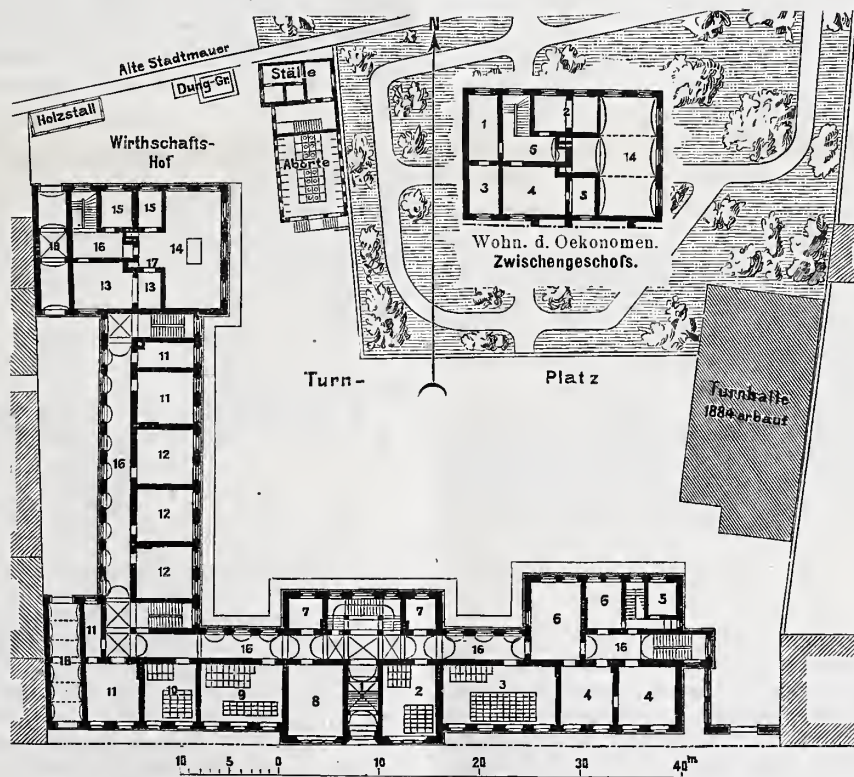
Grundriss vom Erdgeschoss.
